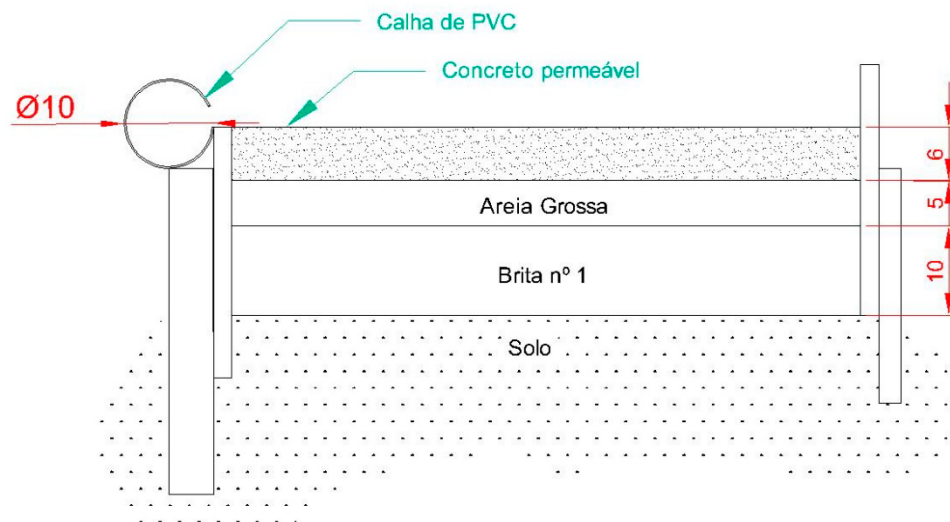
Corte BB' do modelo de pavimento de concreto permeável, com medidas em centímetros
